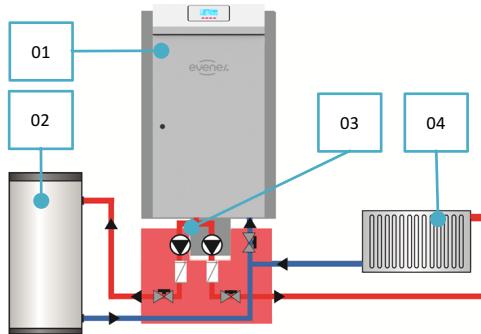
Hydraulics schema – Warmwasserspeicher mit Pumpe
